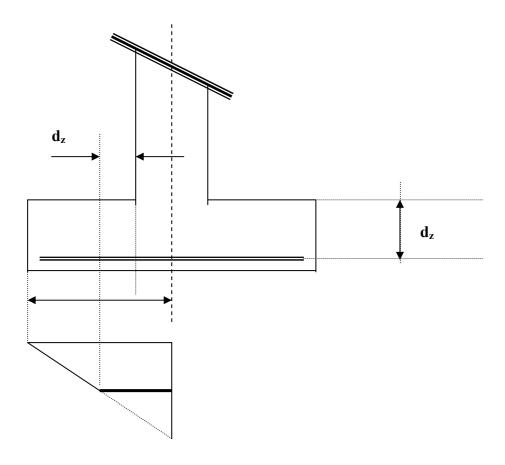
Revisión de la cortante en una dirección ejemplo 12.3
